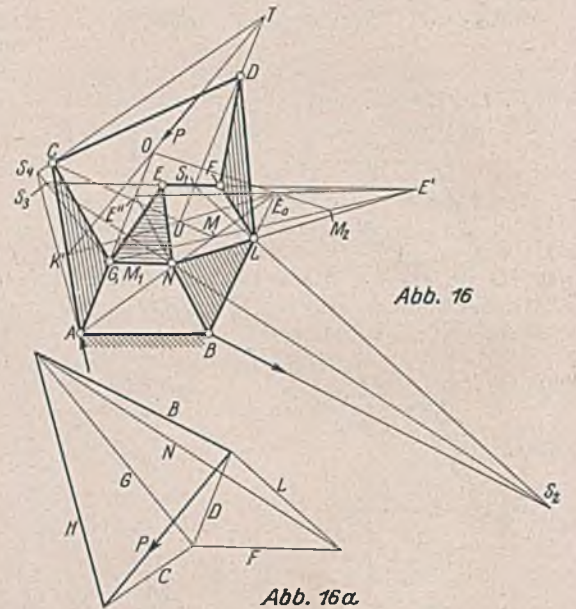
Fachwerk mit dreifacher Umwandlung der Wirkungslinien und Lageplan nach Abb. 13.
